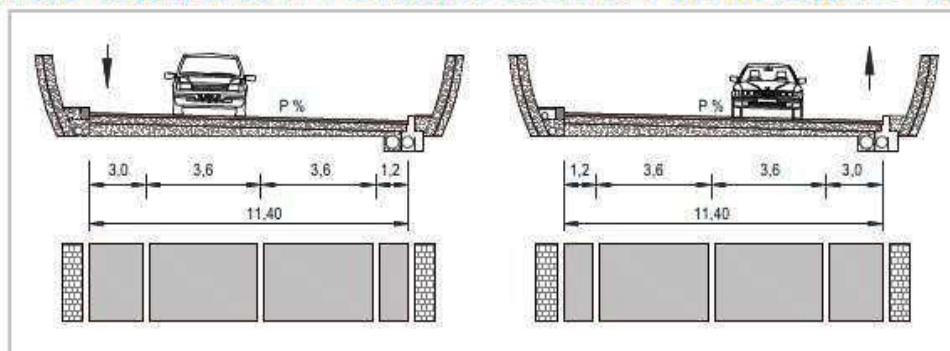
Sección transversal típica de una carretera con calzadas separadas
